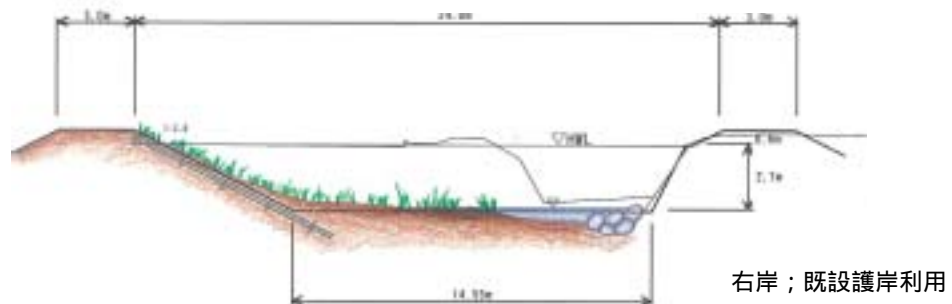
森川標準断面図（横断面はイメージを表す）
